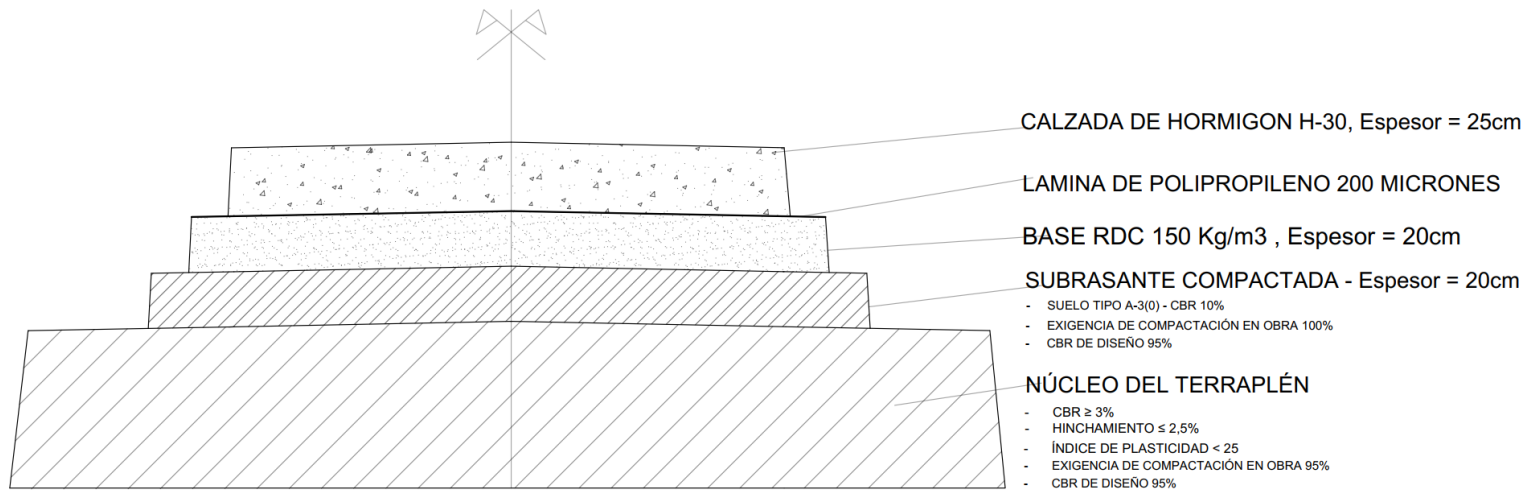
Paquete estructural adoptado. Fuente: Elaboración propia
